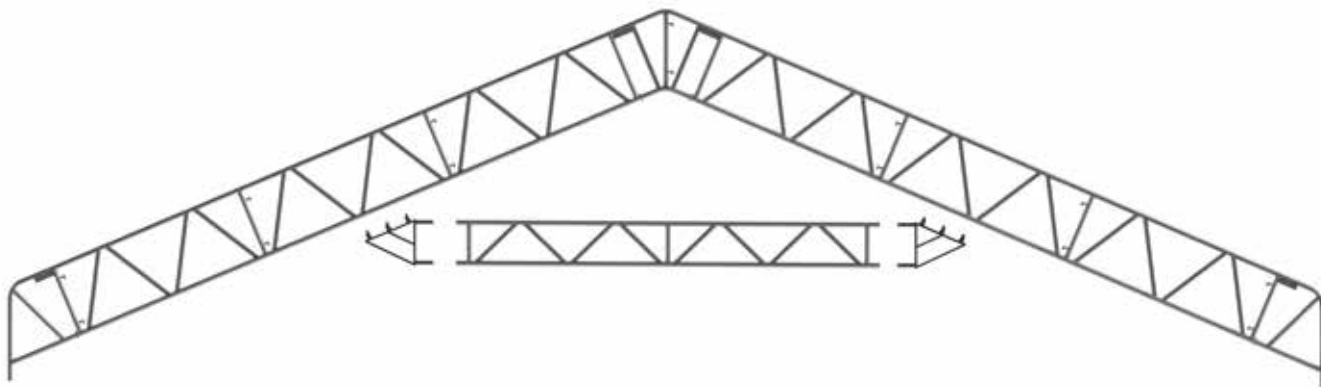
Połączenie łącznika dachowego z dźwigarem dachowym.
